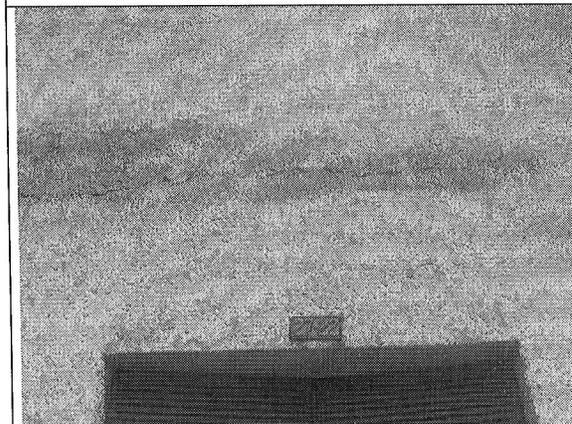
Grieta horizontal a la altura del entrepiso.
